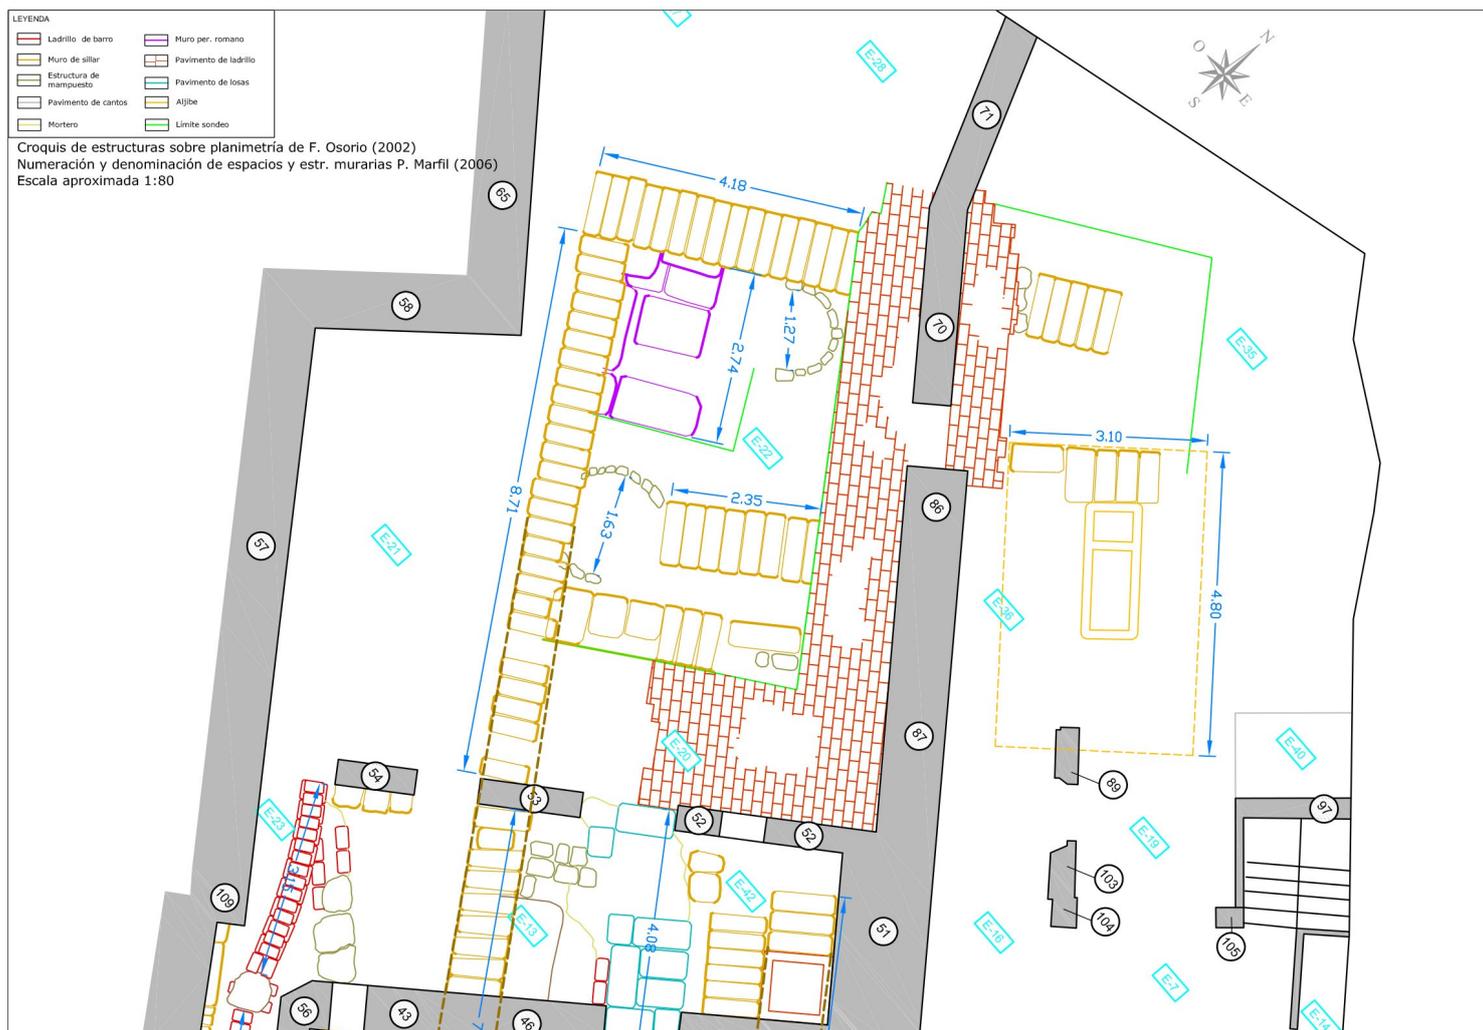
Croquizado Parcial 02 de las estructuras del Baño de la Pescadería o de la calle Cara.
